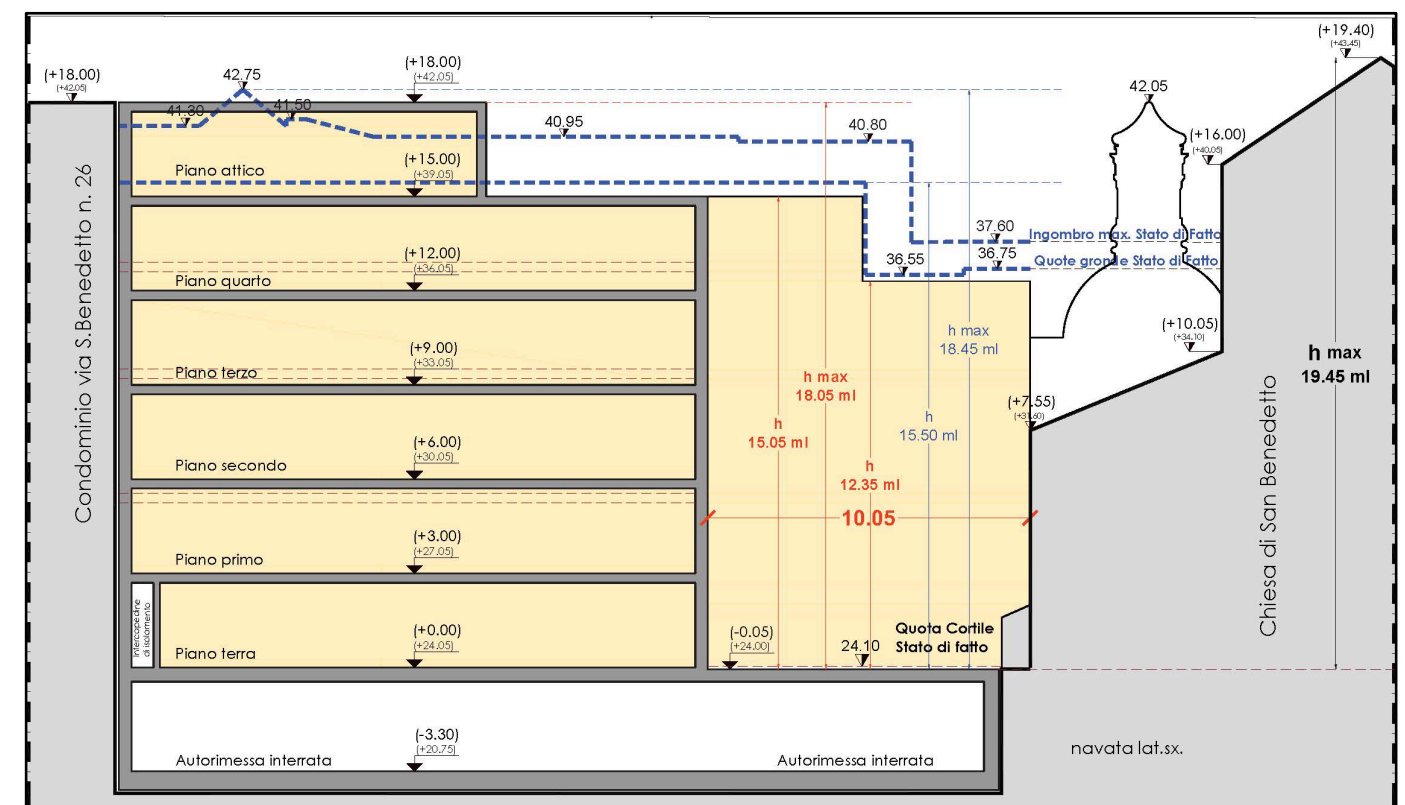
Schema riepilogativo delle altezze dell'edificio in progetto
